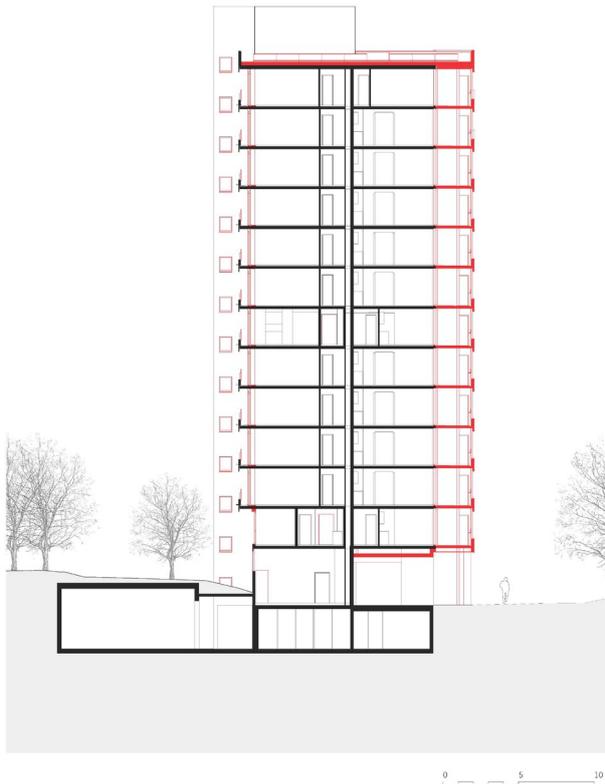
Telli / Querschnitt und Grundrisse vorher & nachher
